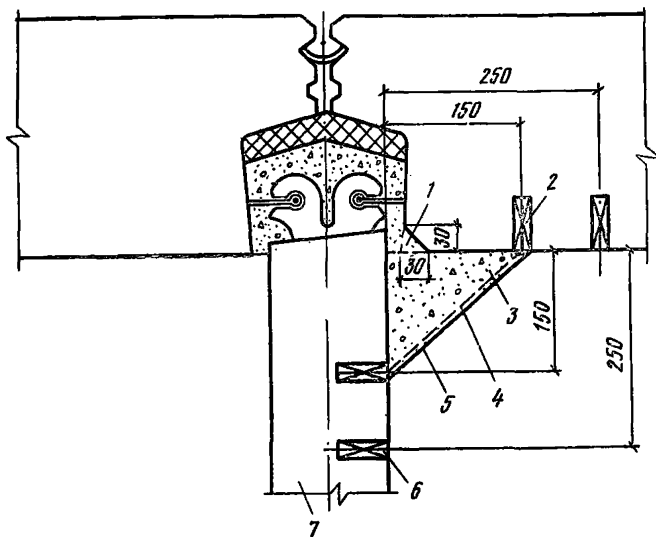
Утепление вертикального рядового стыка в месте примыкания перегородки к наружным стеновым панелям
